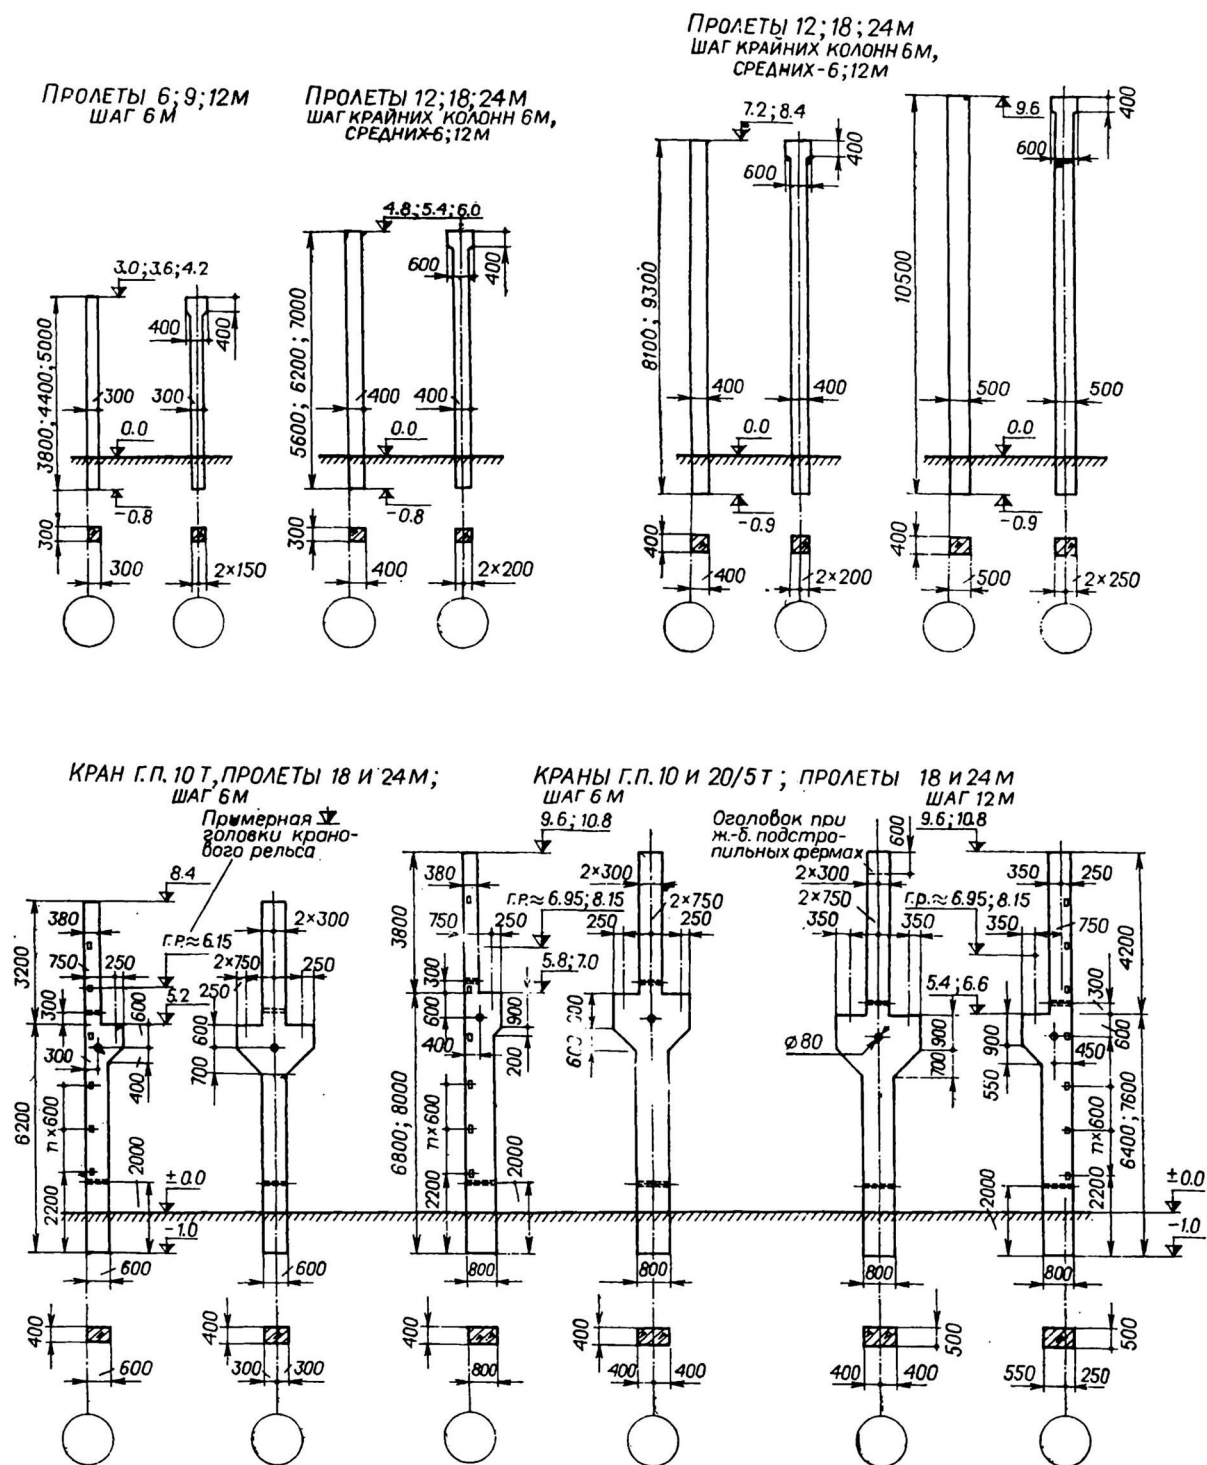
Железобетонные колонны прямоугольного сечения для зданий без опорных кранов высотой 3,0–9,6 м и 10,8–14,4 м (серия 1.423-3 и 1.423-5) и с кранами грузоподъемностью 5, 10 и 20 т (серия КЭ-01-49)
